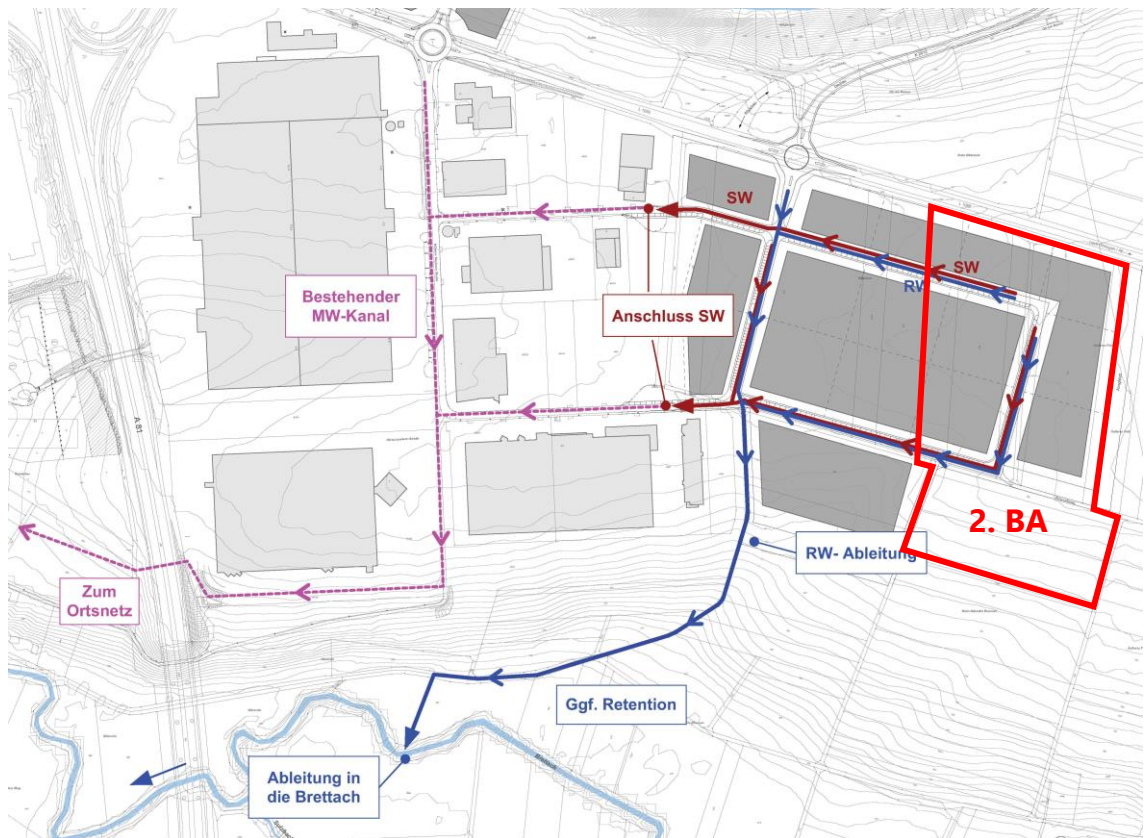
Systemskizze Entwässerungsplanung - Rahmenplan (Quelle: IFK-Ingenieure, 2015)
